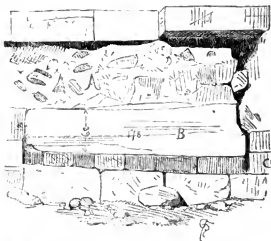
Fondations de la façade méridionale au cinquième pilastre.
